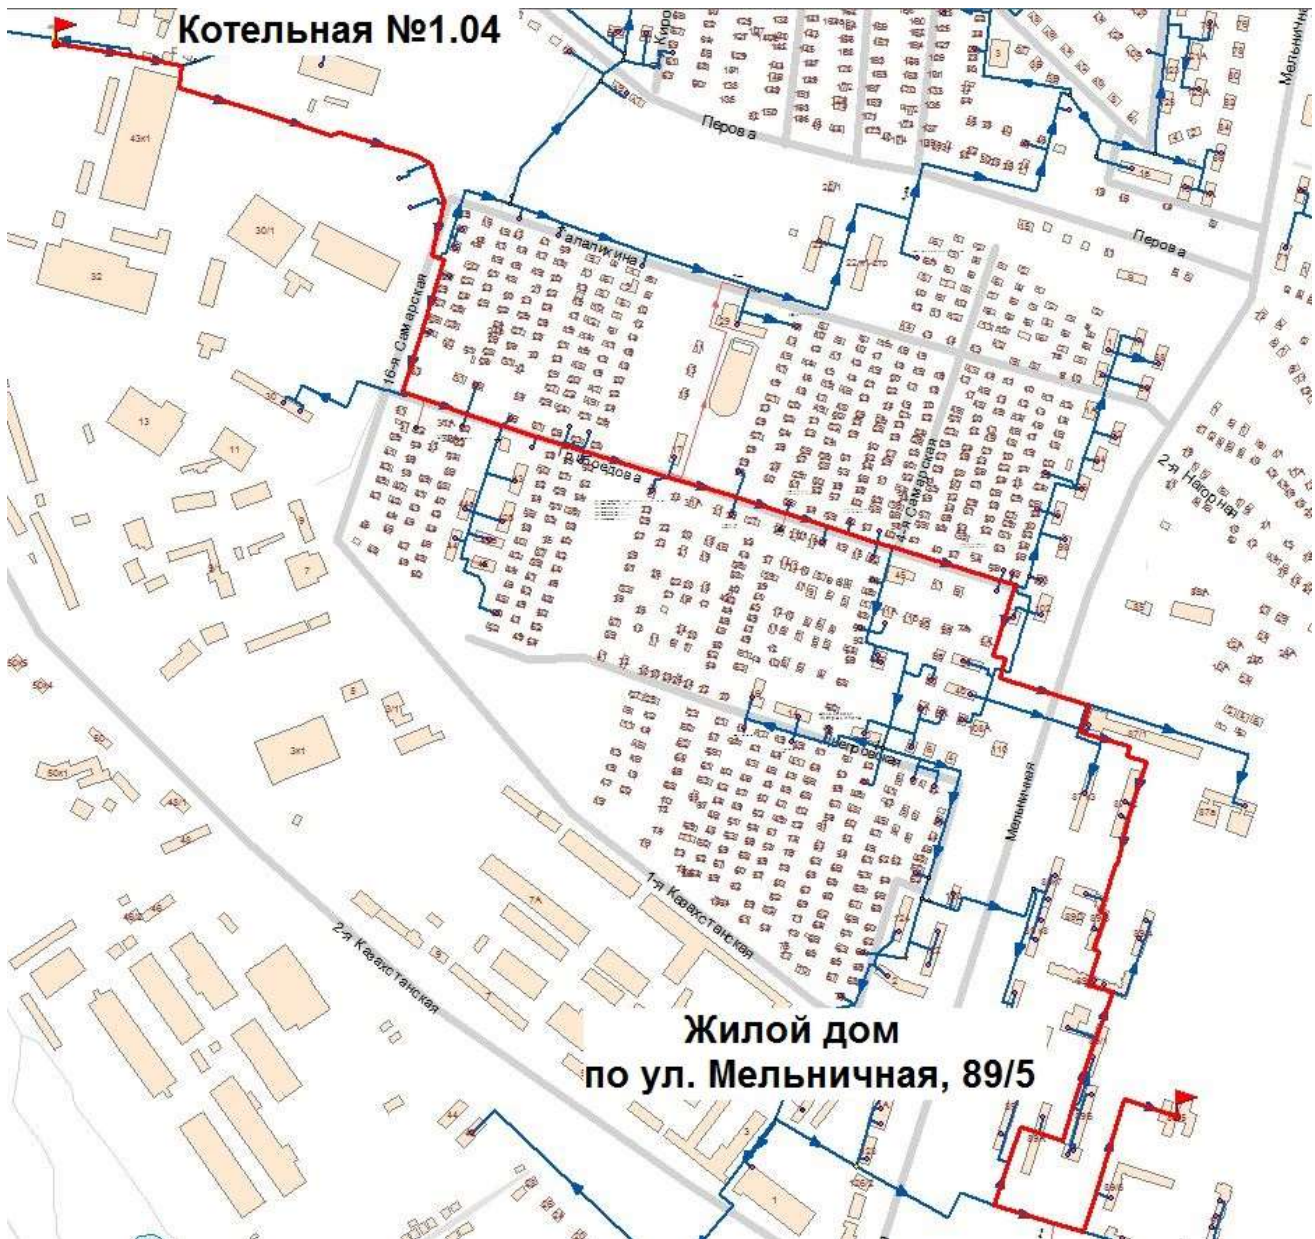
Трассировка теплопровода от Котельной 1.04 до жилого дома по ул. Мельничная, 89/5
